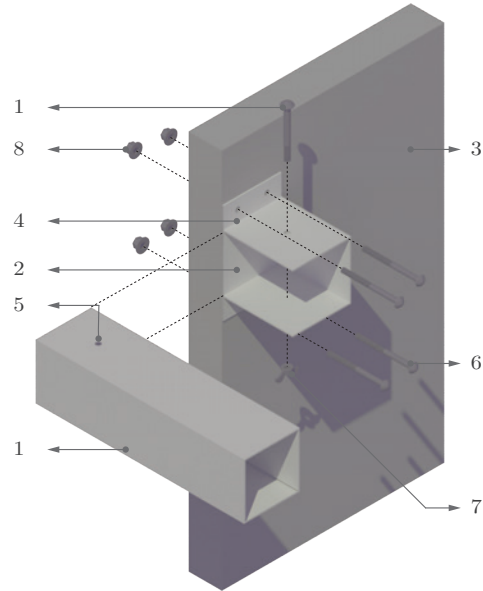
Detalle de la conexión de la cubierta externa del habitáculo Emergency Expa Room. Fuente y elaboración: Autores.
